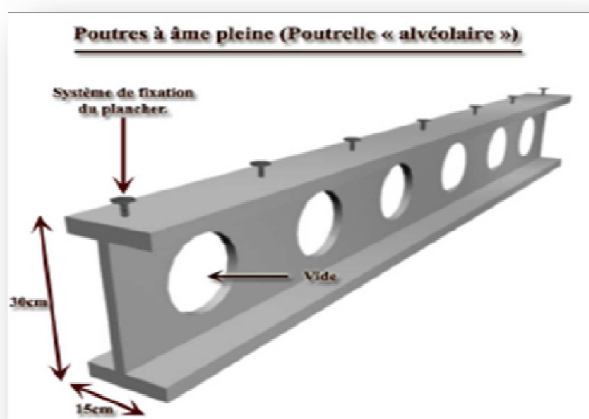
Poutre à âme pleine (poutrelle alvéolaire).
